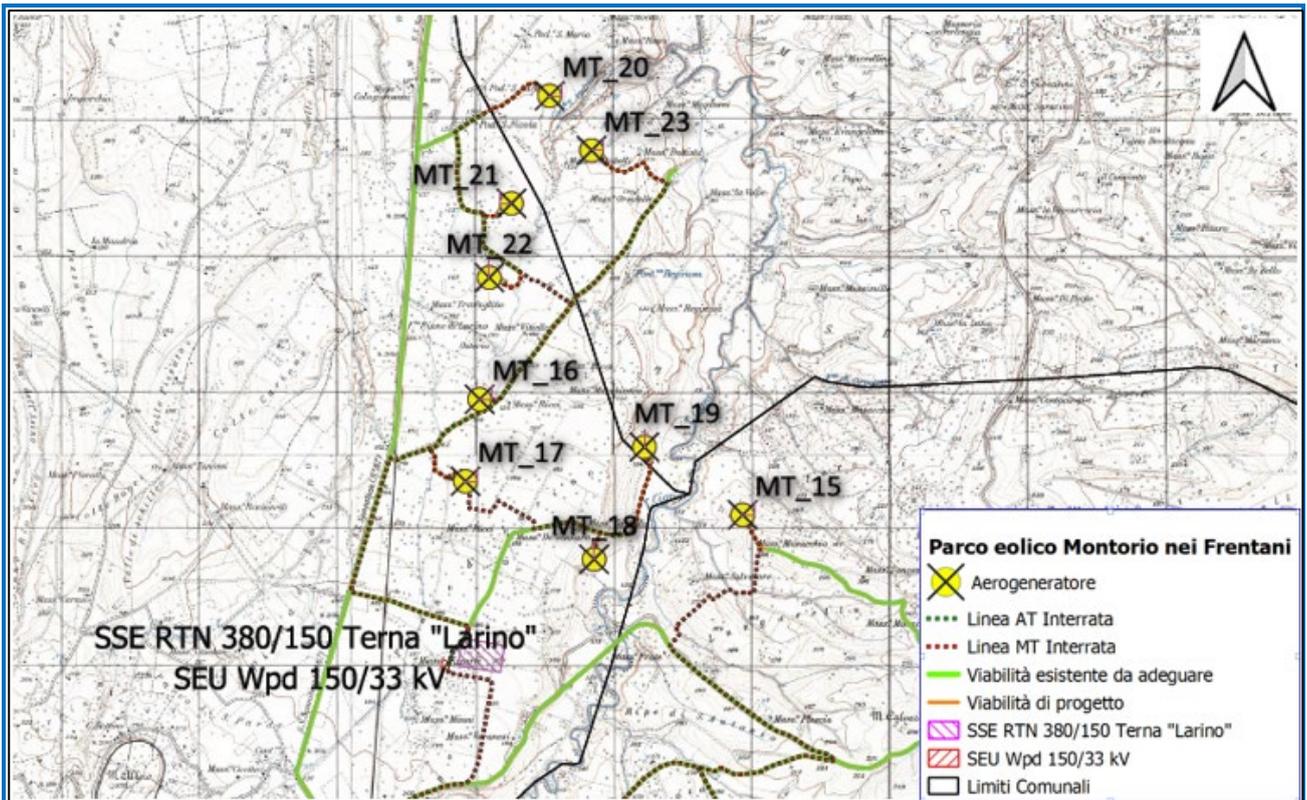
Layout d'impianto: Zona 1 su IgM
